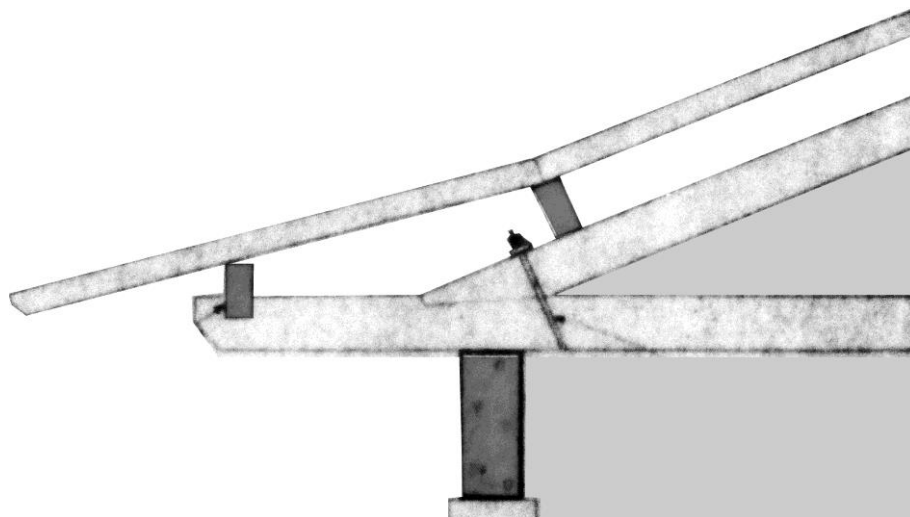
Padrão CM2 - Detalhe da cobertura em corte, sem laje de forro, com galbo e viga de apoio do telhado (CARPE, 1969 alterado pelo autor)
